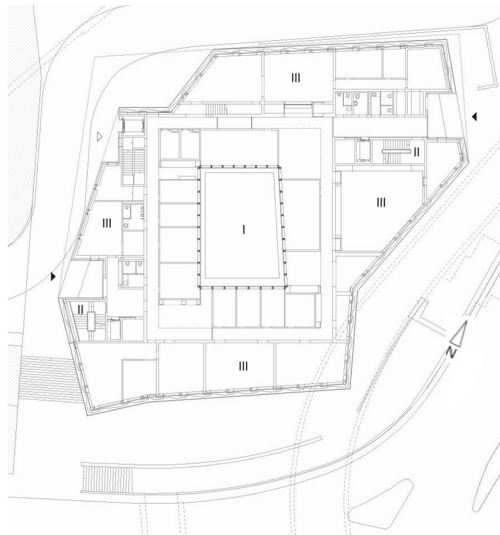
Grundriss Erdgeschoss M 1:1000
